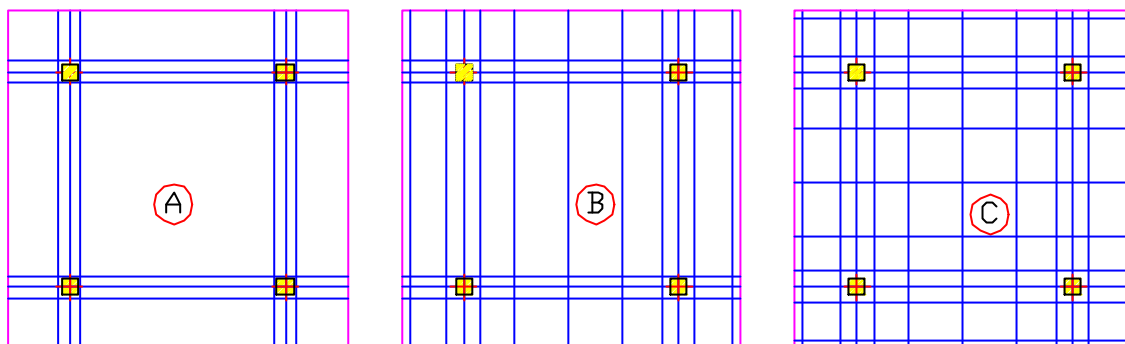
Lajes Planas Maciças sem Capitéis (Lajes Lisas)
